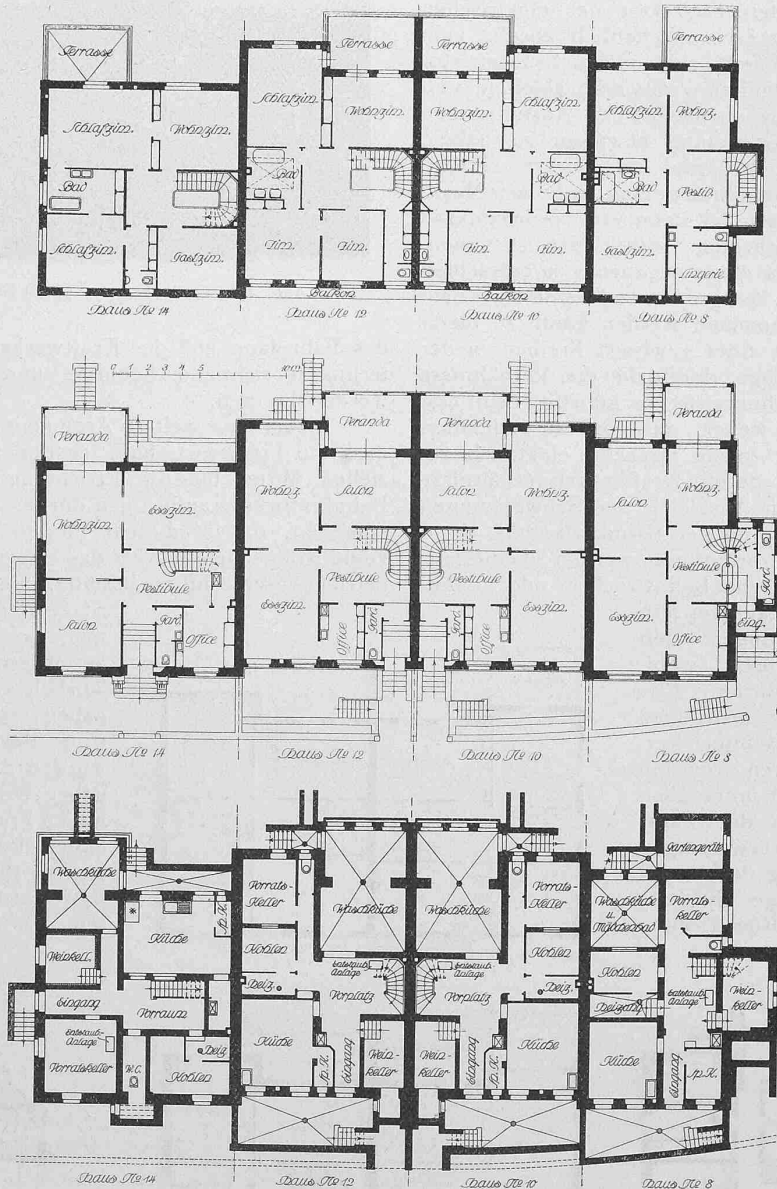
bis 12. Grundrisse der Häuser Lautengartenstrasse Nr. 8 bis 14 (Tafel 20 und 21). — Masstab 1:400.
